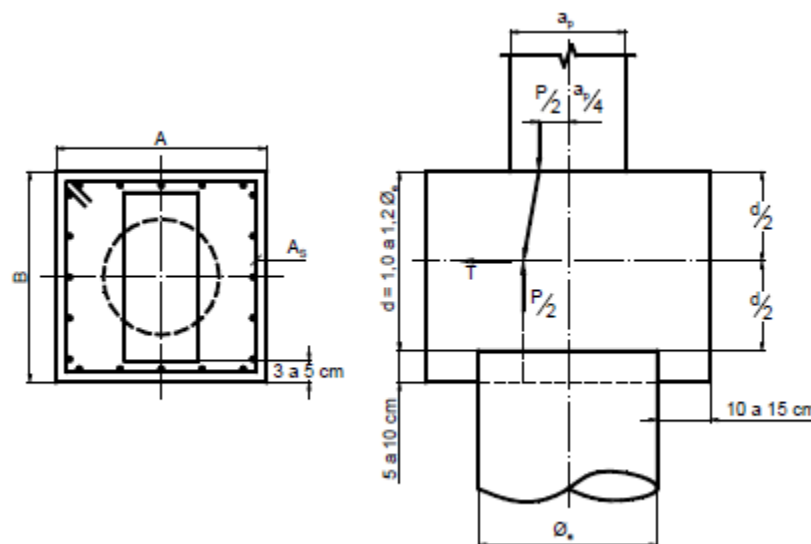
bloco sobre uma estaca: esquema de forças e detalhes das armaduras (Bastos, 2017)
